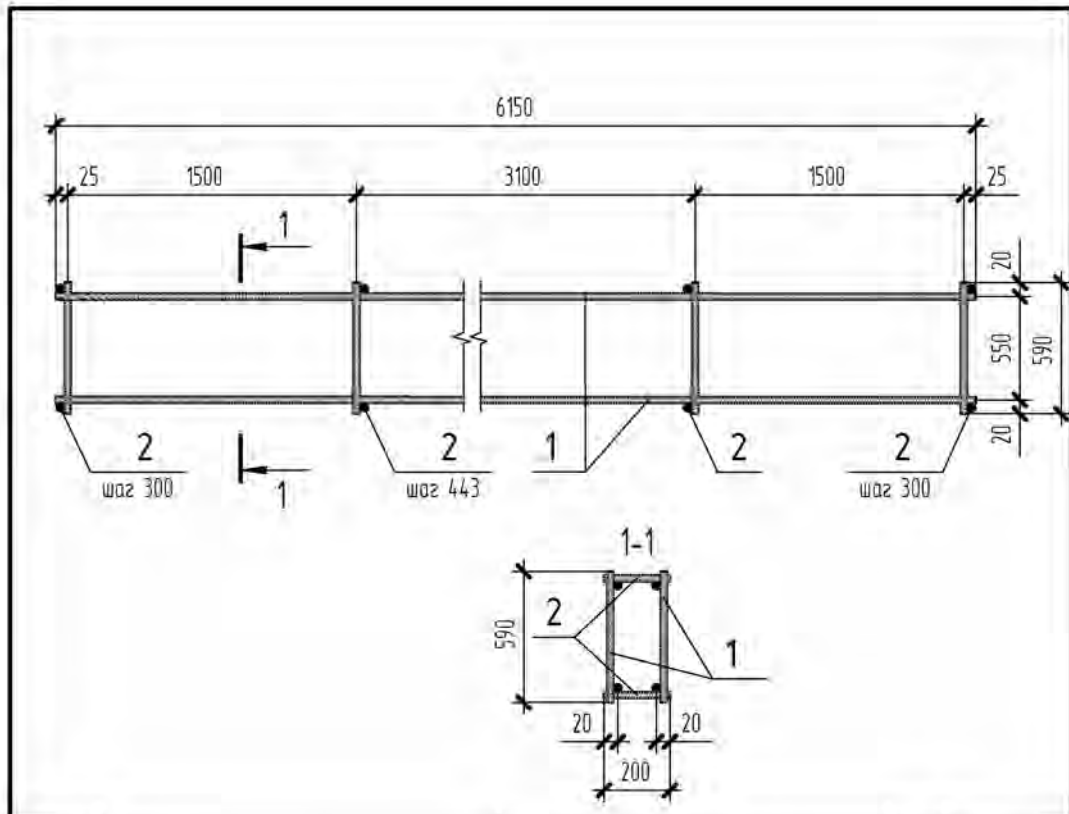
Рабочий чертеж арматурных сеток С1 и С2 для фундамента ФМ10
